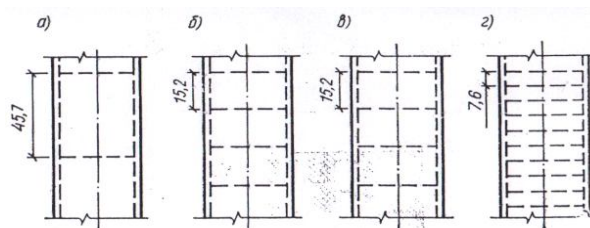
Поперечное армирование колонн: а – обрушившегося первого этажа больницы «Оливе Вью»; б – г – по нормам США разных лет (диаметр хомутов по схеме «в», больший чем по схеме «б») [2].
